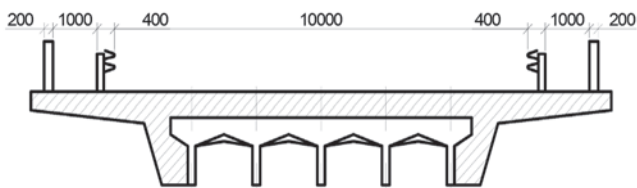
Розширення лівобережної прогонової будови монолітною залізобетонною плитою з контурними ребрами підсилення крайніх балок
